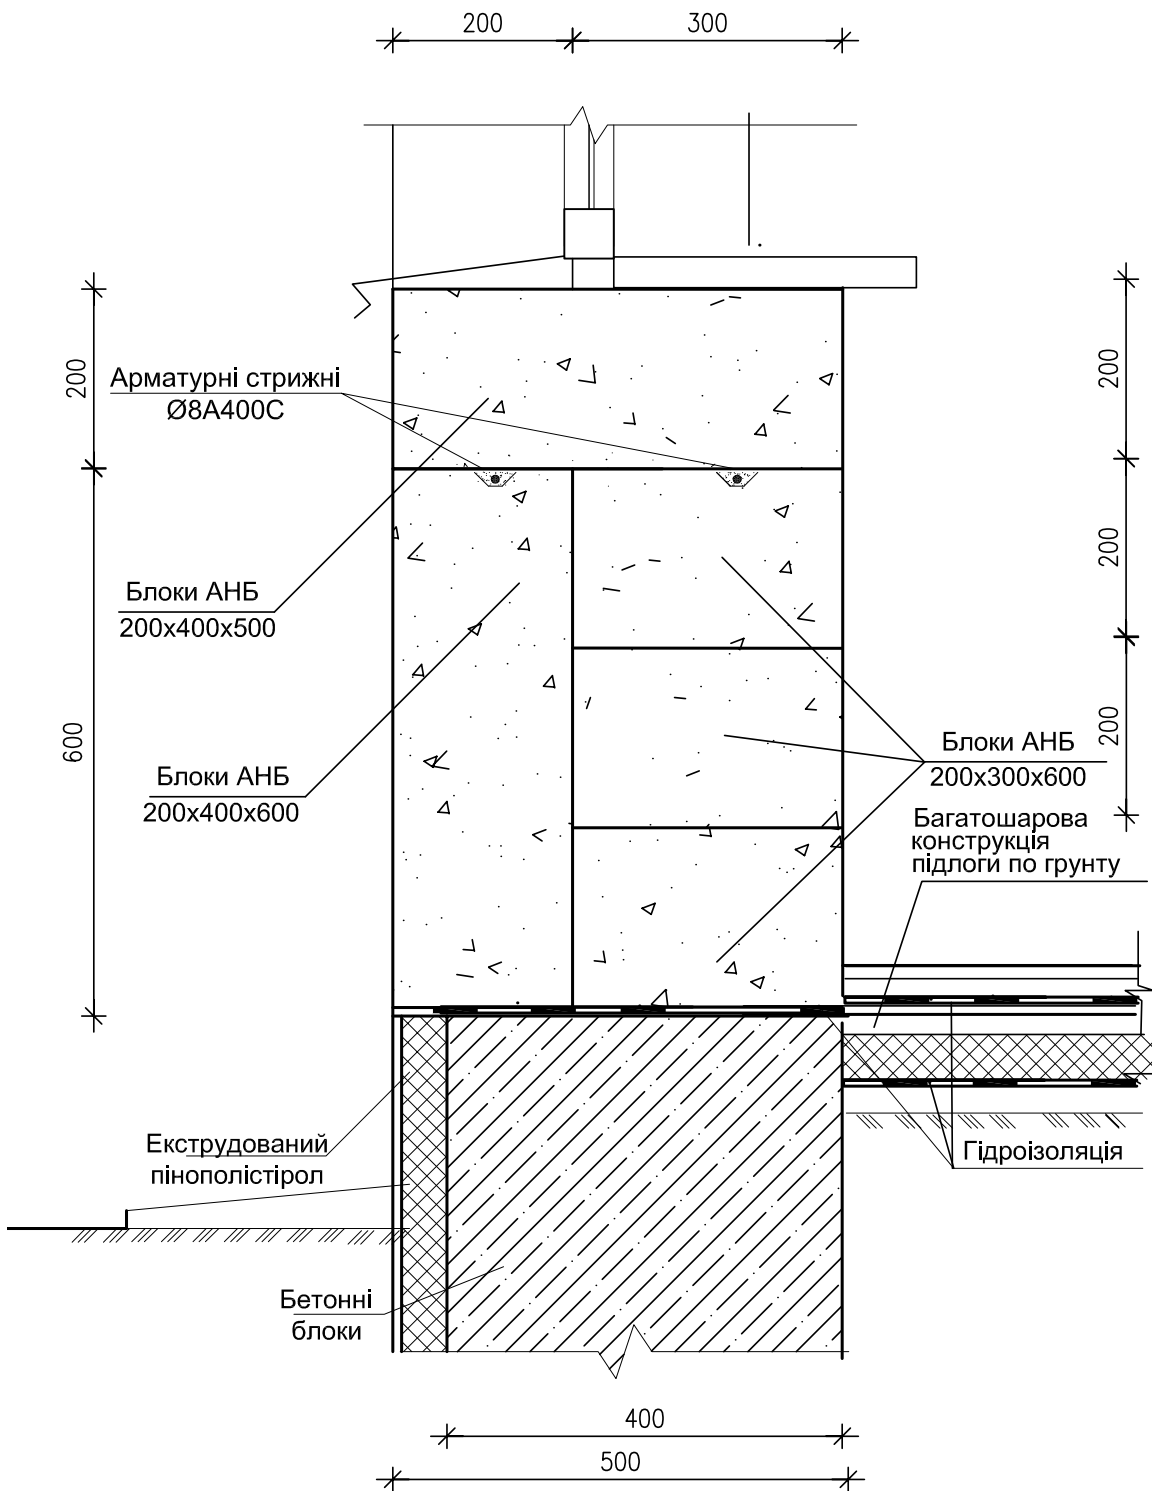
Двошарова стіна другого типу. Вузол спираєння стіни на блок фундаменту.
